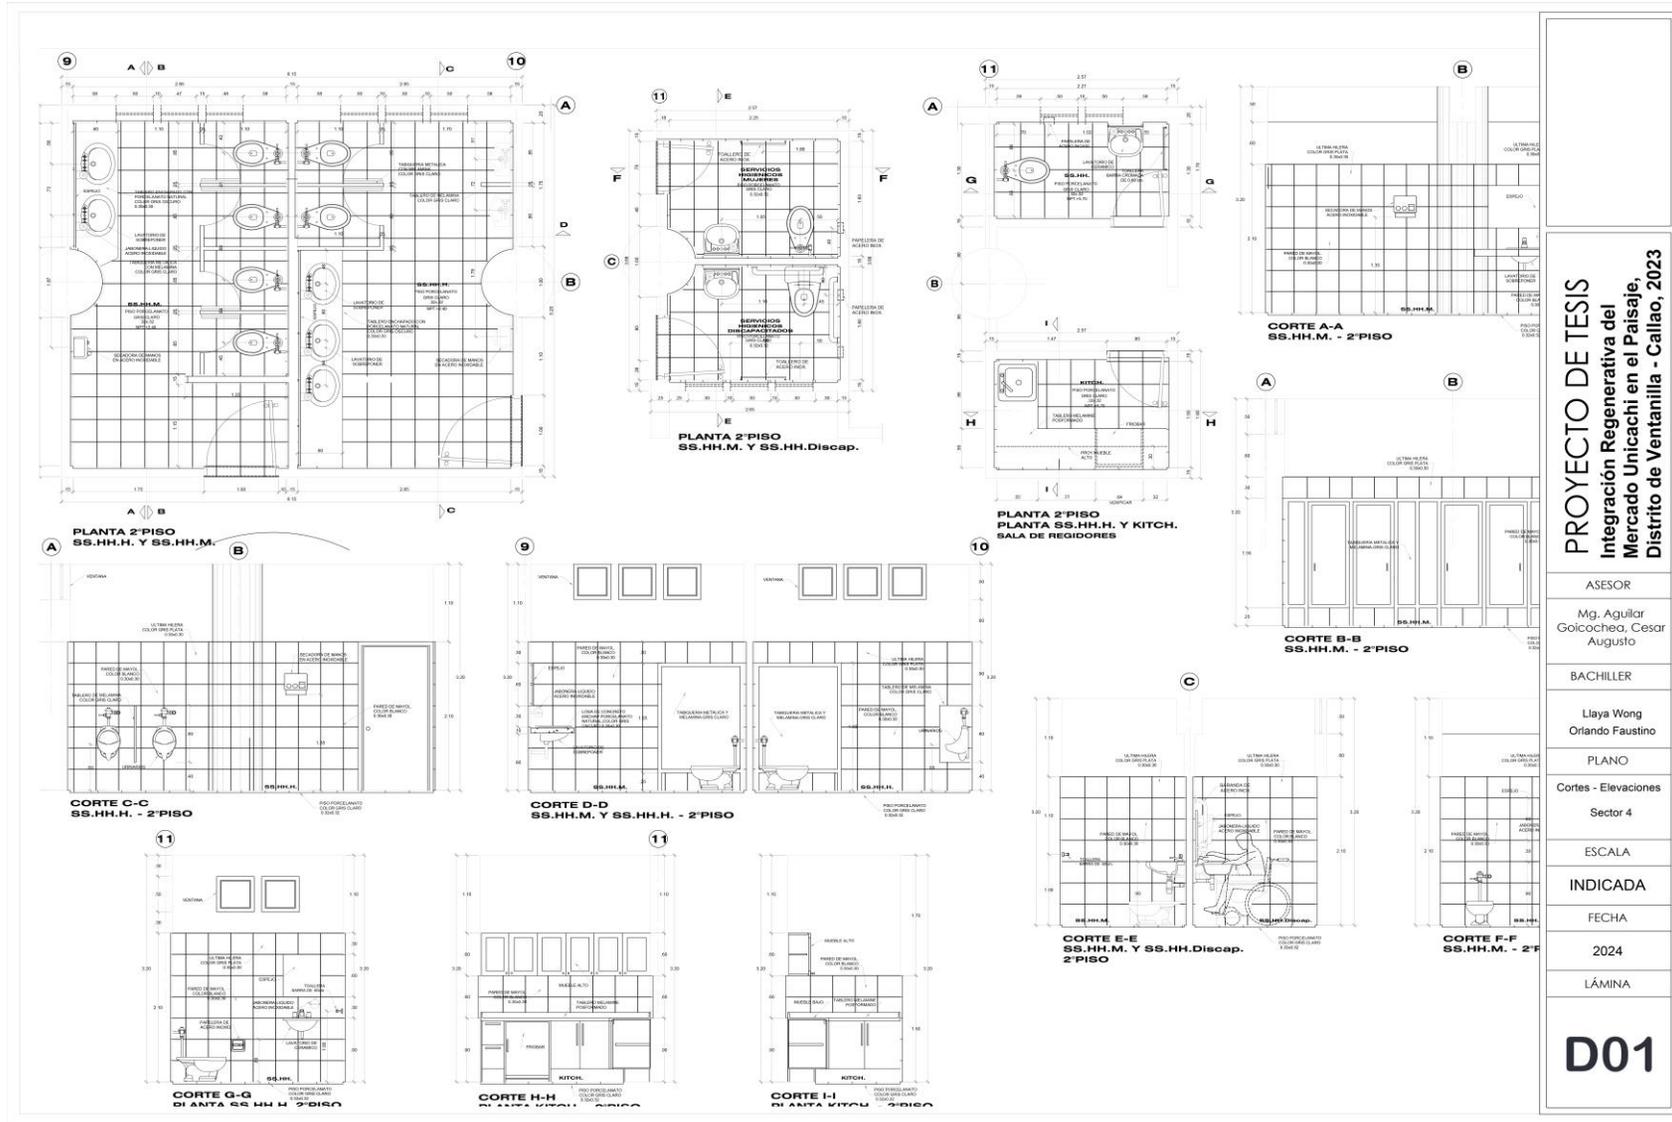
Plano de Cortes elevaciones de sector IV – Plano II y Isometría General, elaboración propia.
